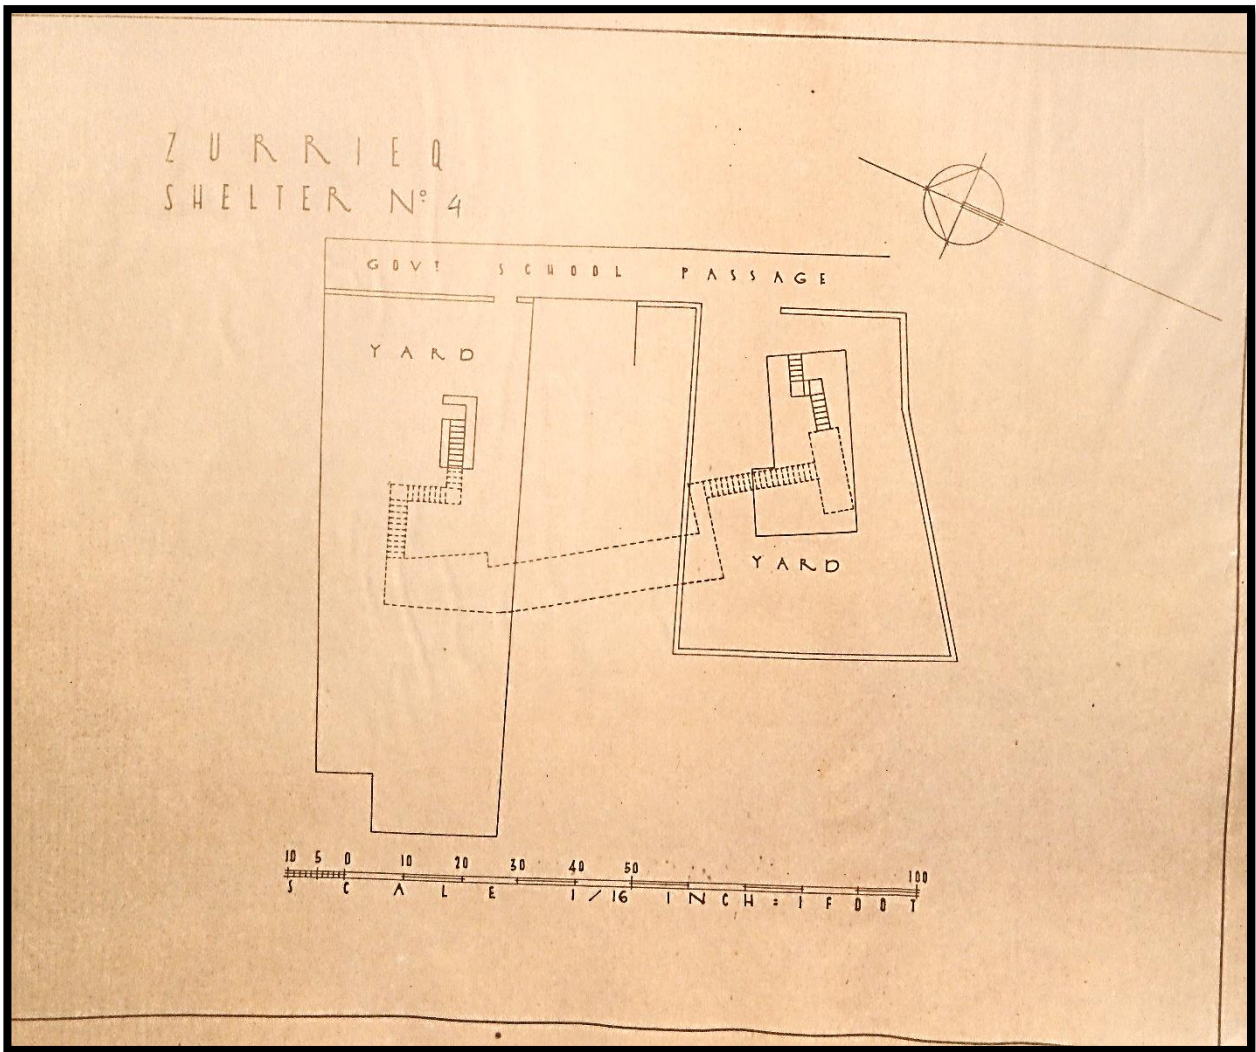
Planta do Abrigo nº4 "Govt. Scholl Passage"
